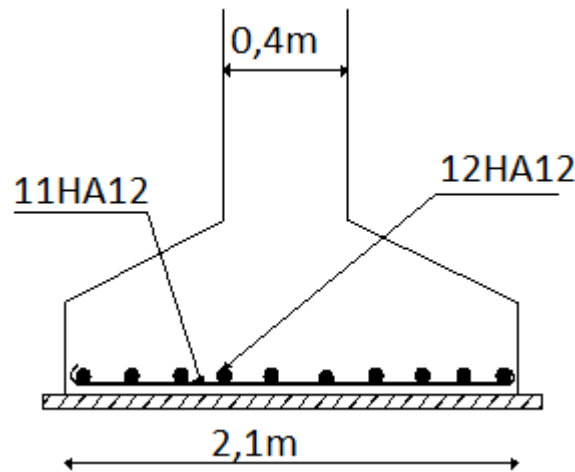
Schéma de ferrailage de la semelle type 1.
